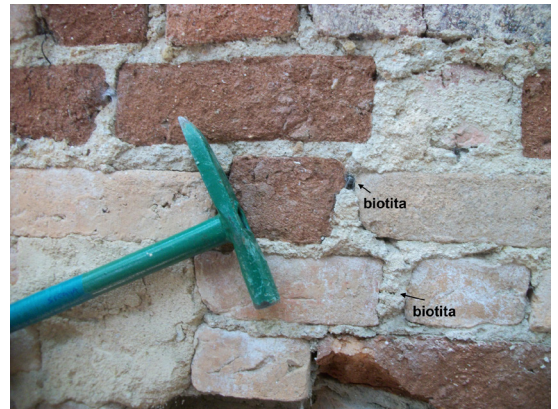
Argamassa de assentamento em alvenaria de tijolo da Casa dos Veterinários. Foto dos autores, 2016
